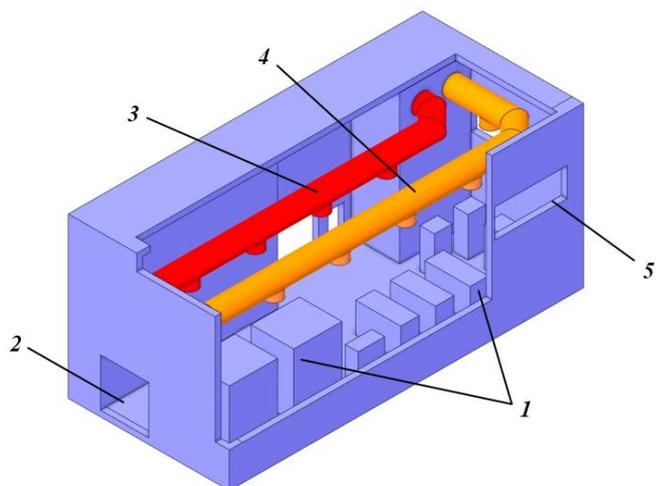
Трехмерная модель цеха завода металлоконструкций: 1 – технологическое оборудование; 2 – наружные ворота; 3 – воздуховод приточной вентиляции; 4 – воздуховод вытяжной вентиляции; 5 - окна
